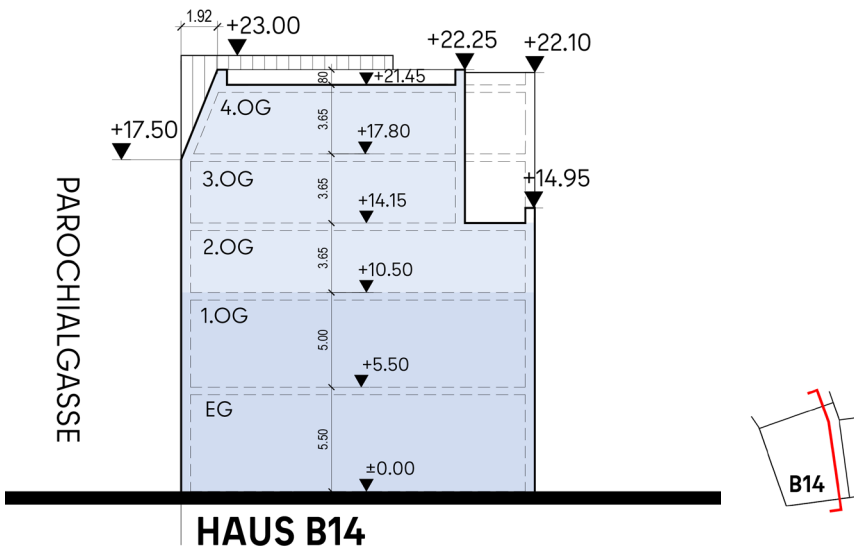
Schematischer Querschnitt 1 Haus B 14 (Abtreppung aufgrund der Abstandsflächen zum Gartenhof)
